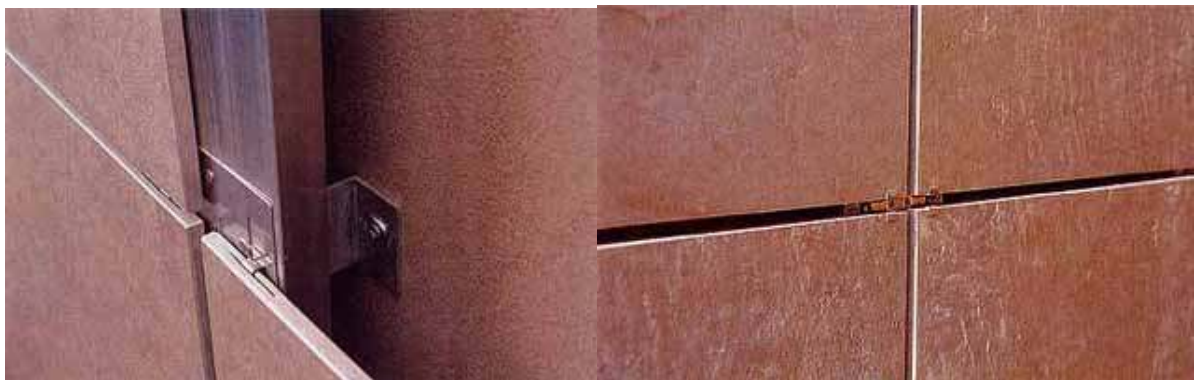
Distintas fases del montaje de la perfilaría de una fachada ventilada sistema FV.
